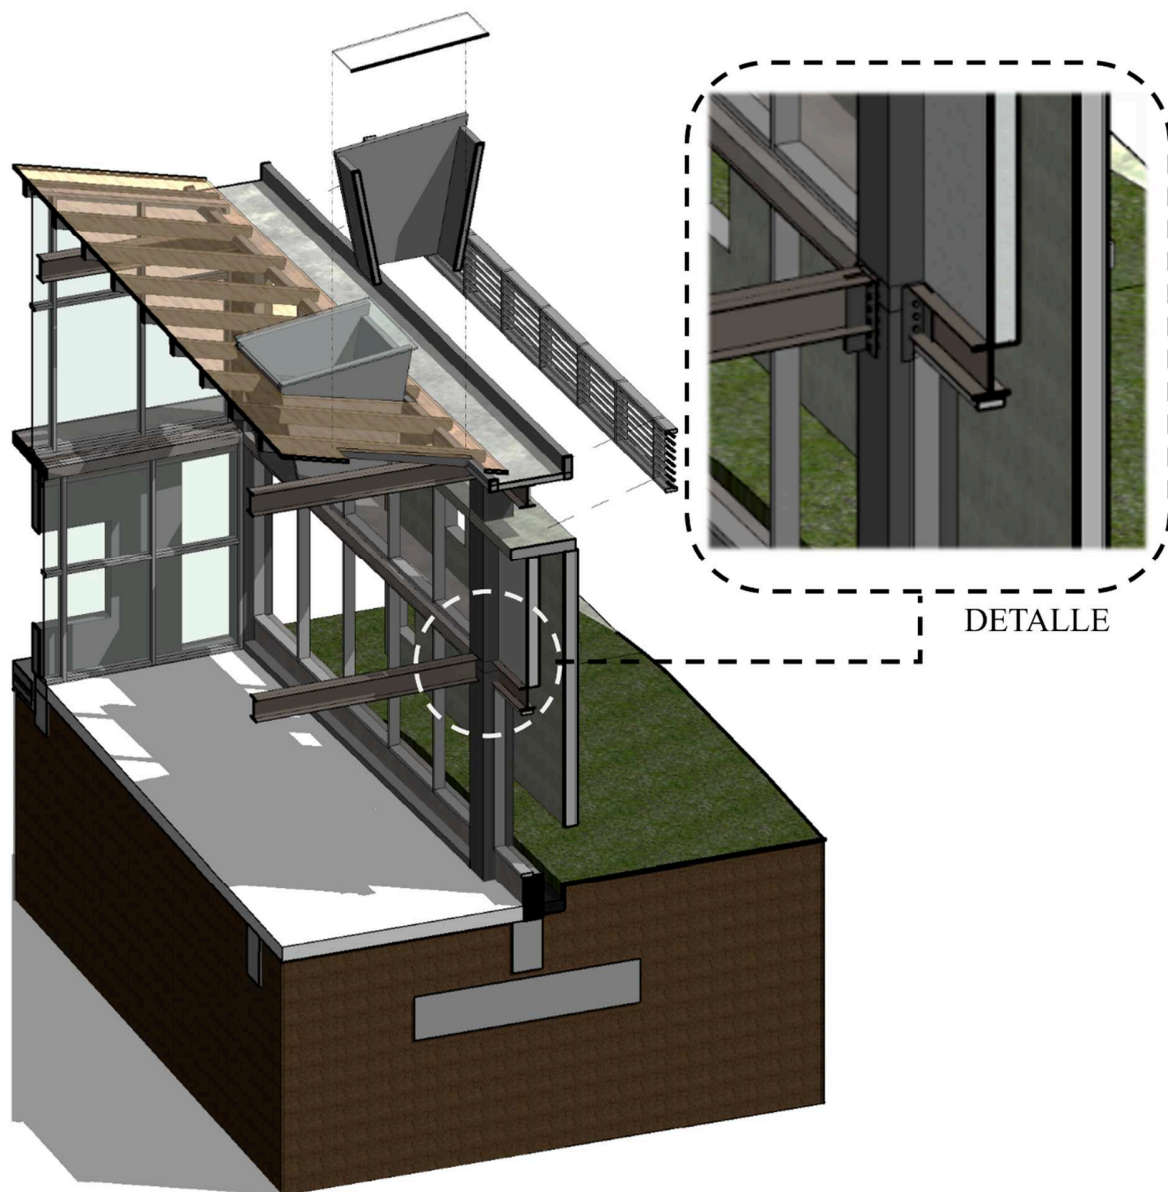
Detalle axonometría propuesta estructural. Elaboración propia.
